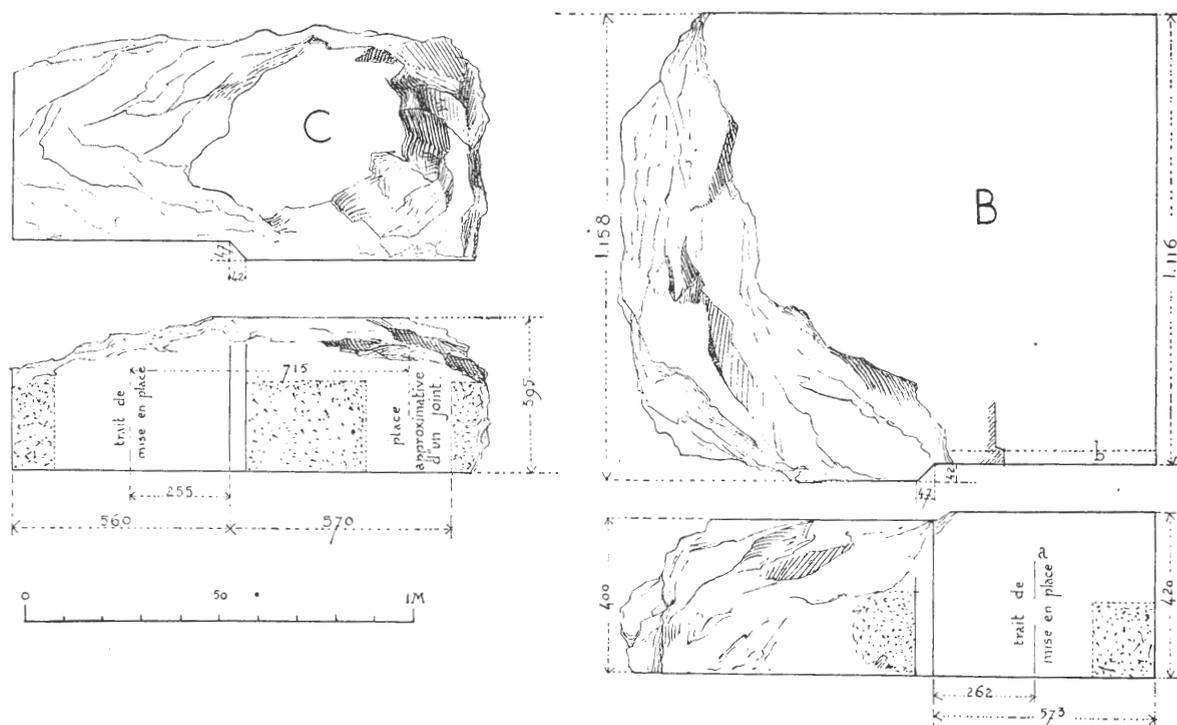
Dalles des péristyles latéraux, avec ressaut sur une des tranches.
